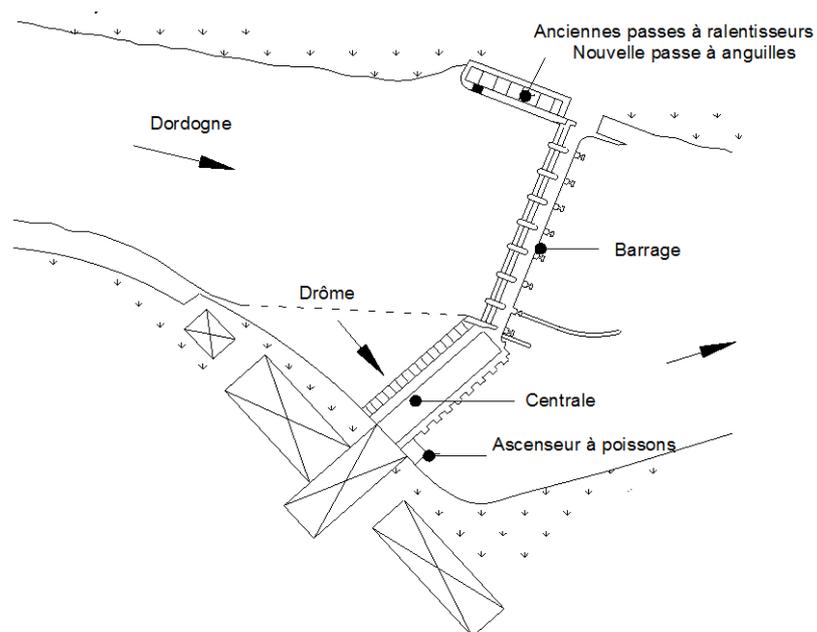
Localisation de la passe à anguilles sur le site de Tuilières
